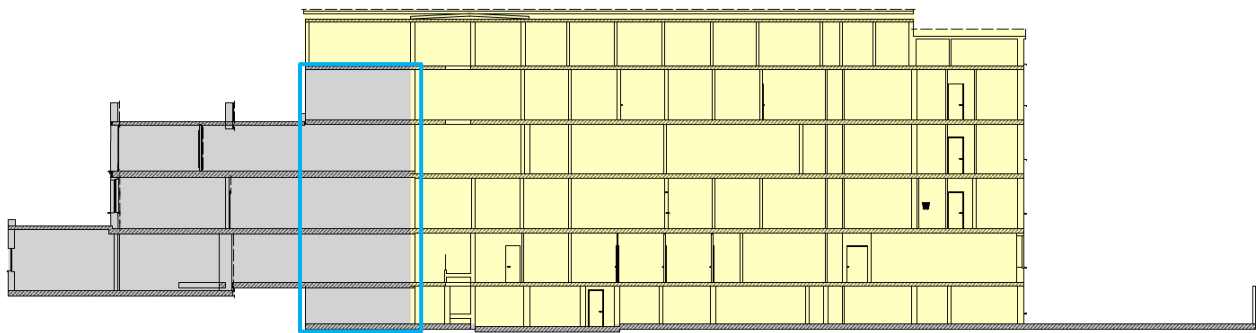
Schnitt 2-2 mit Kennzeichnung von Abbruch (gelb) und Bestand (grau) sowie des erhaltenen Gebäudeteils der KJP ohne Dachgeschoss (blau).
